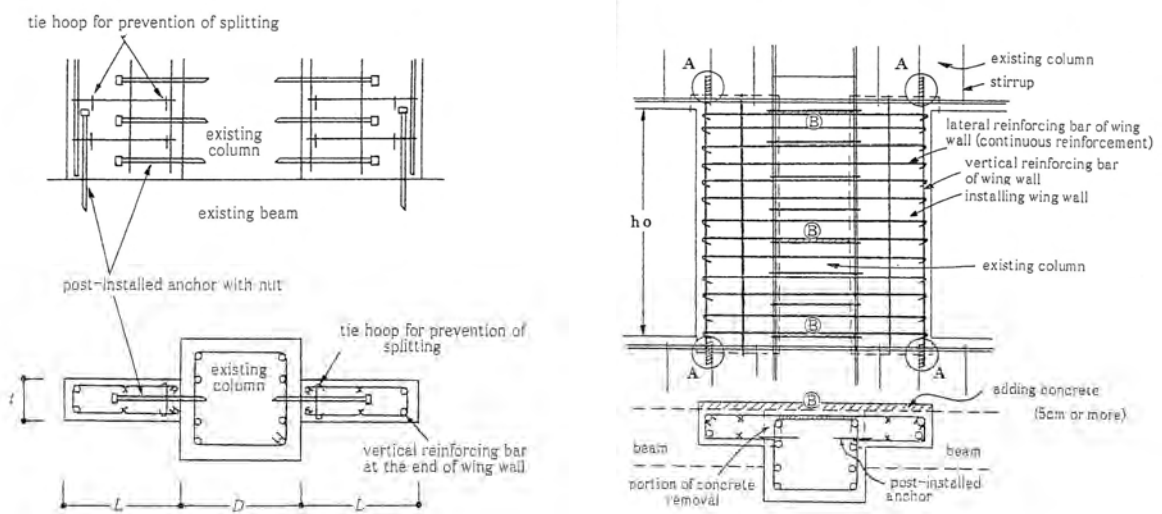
Élévation du cadre aux murs en aile de renforcement (Case 2)
